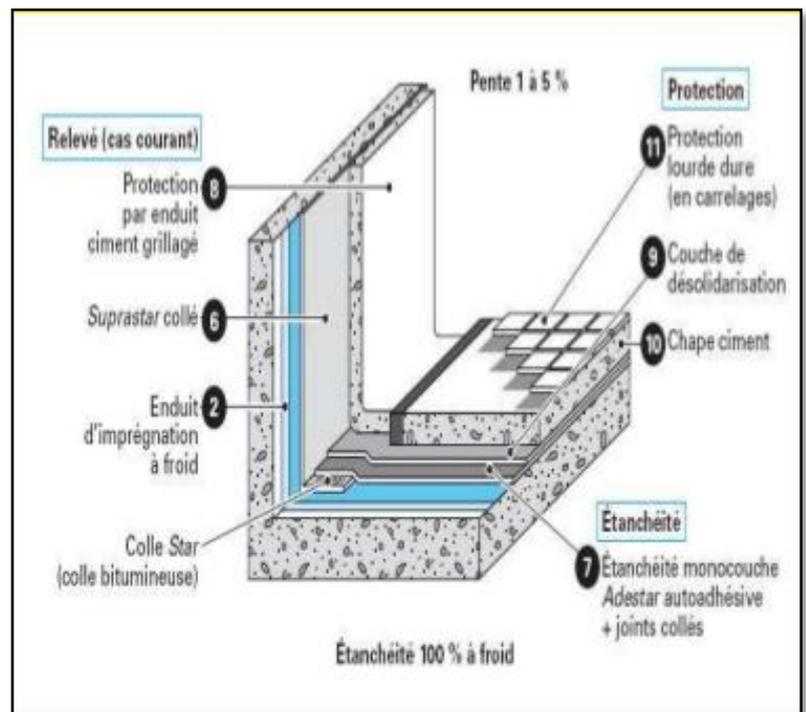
étanchéité de toiture-terrasse accessible¹³².
